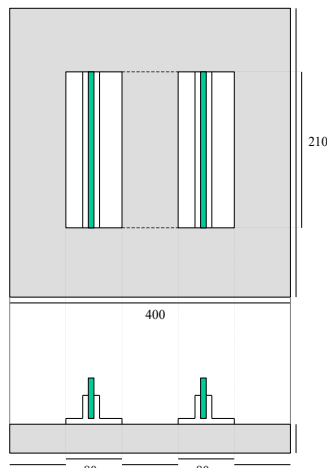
Fondation filante et bac de sable/ Strip foundation and sand container.
